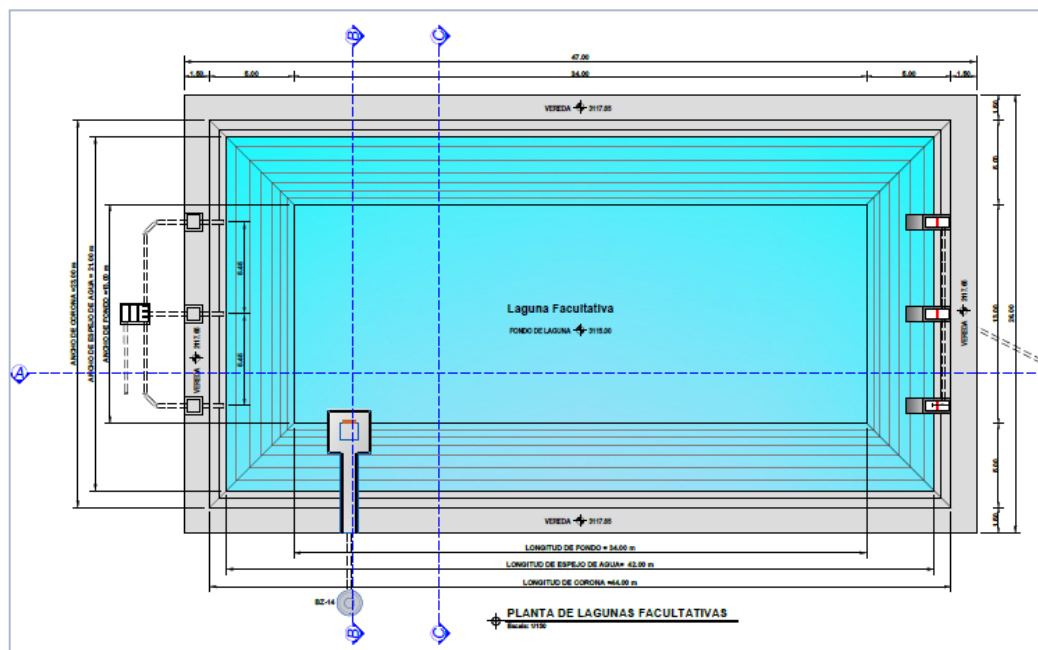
DETALLE DE LAGUNA SECUNDARIA PLANTA
